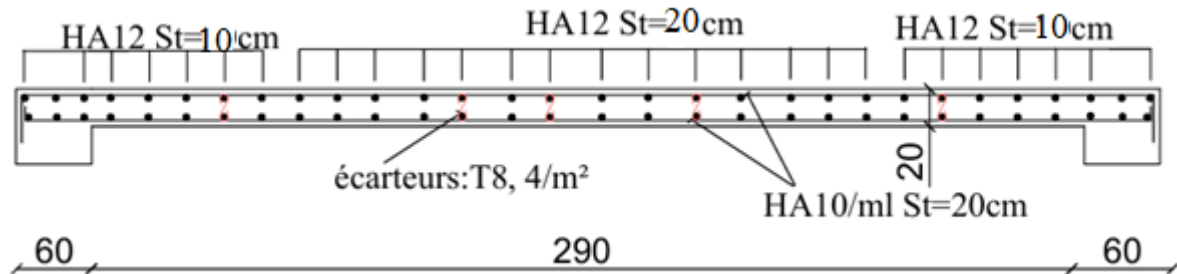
Schéma de ferrailage des voiles (Sens y-y)
